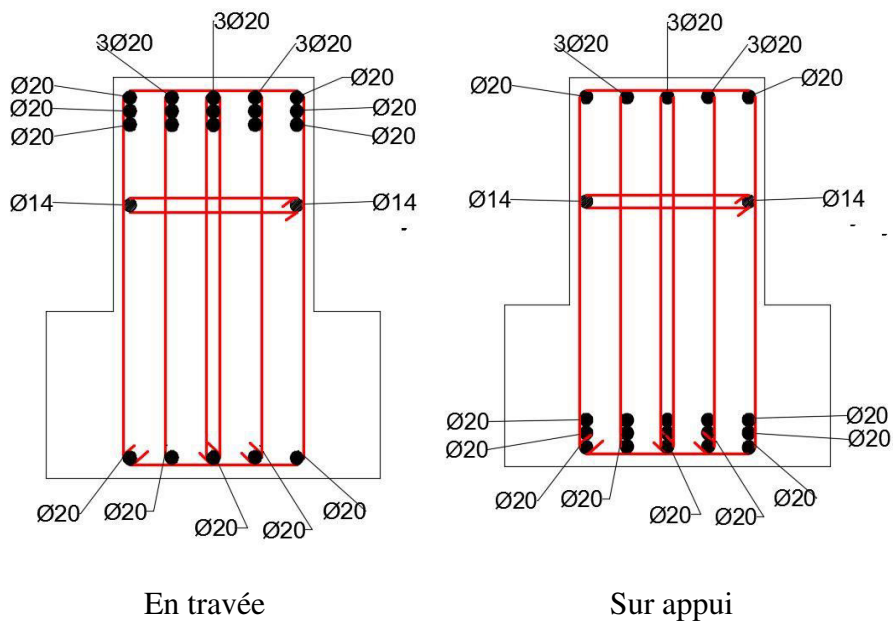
Coupe transversale du ferrailage de la nervure en travée et sur appui
